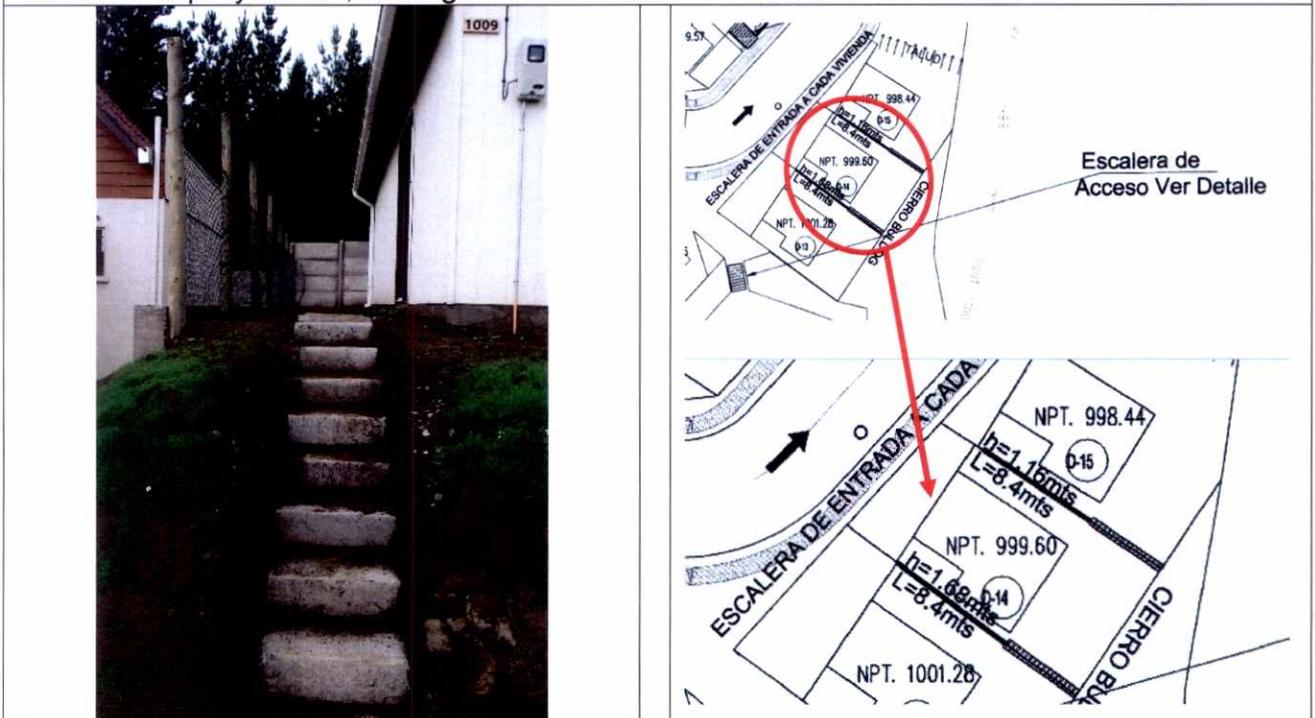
Vivienda emplazada en sitio D-06 sin escalera proyectada e imagen de la escalera graficada en la lámina N° 4 "Escaleras de acceso a viviendas", del proyecto modificado.
